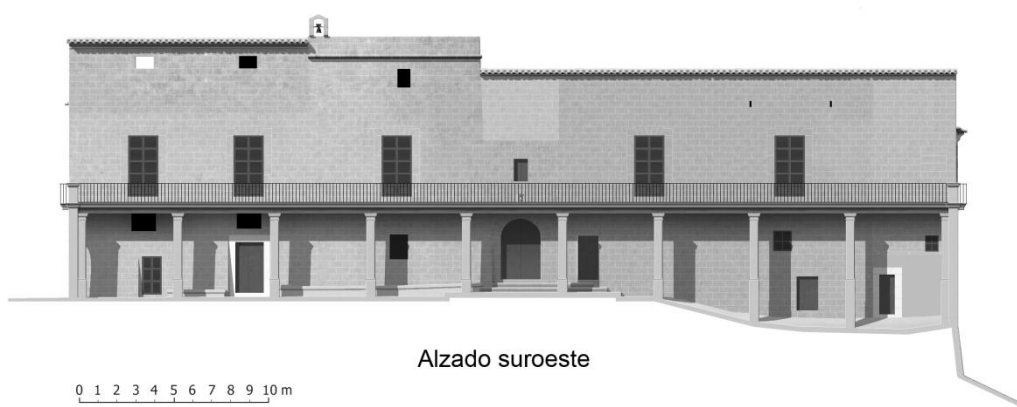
Alzado de *Son Fortuny* con la galería y el pórtico con la barandilla original. Fase 13.
